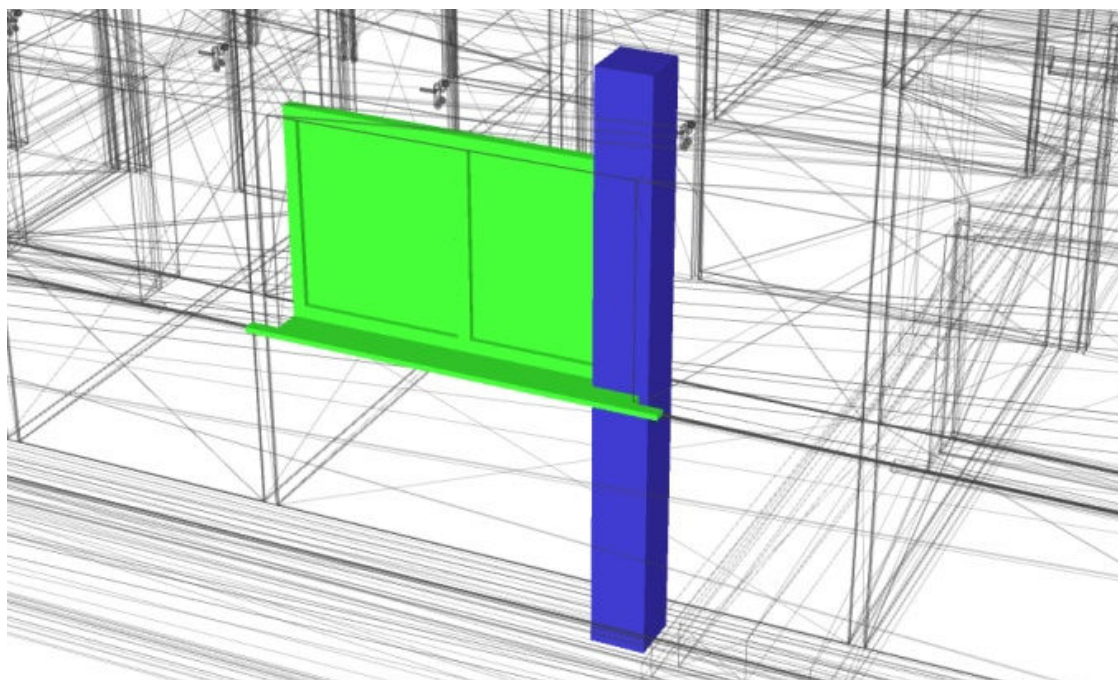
Esempio di interferenza rilevata durante la Clash Detection riguardante il posizionamento delle finestre rispetto ai pilastri strutturali.
